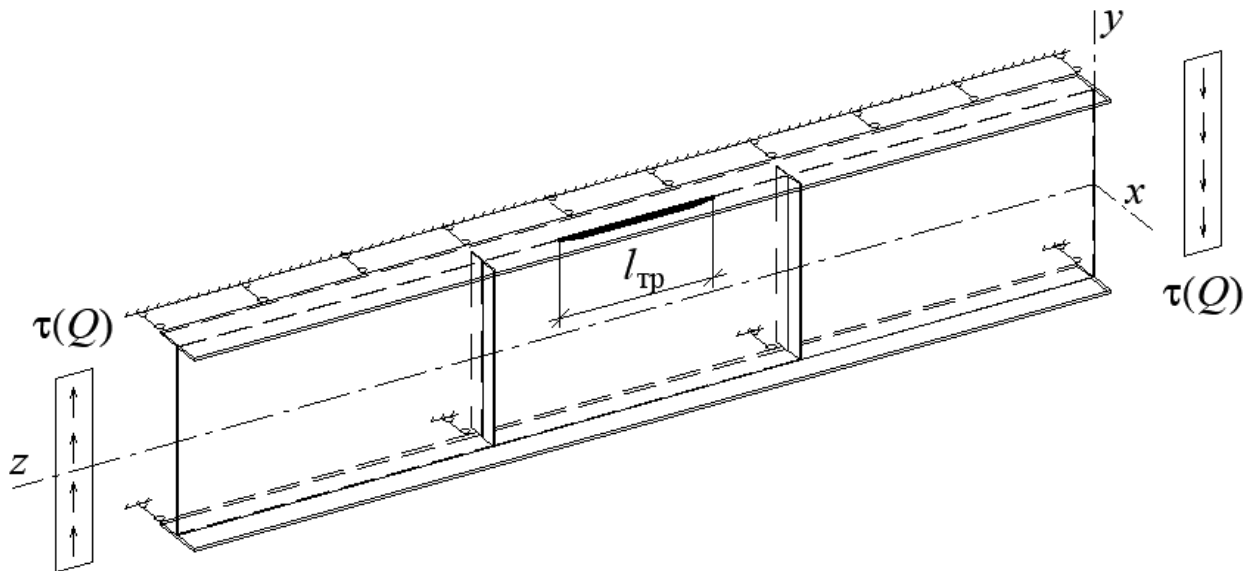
Расчетная схема подкрановой балки с трещиной при чистом сдвиге
